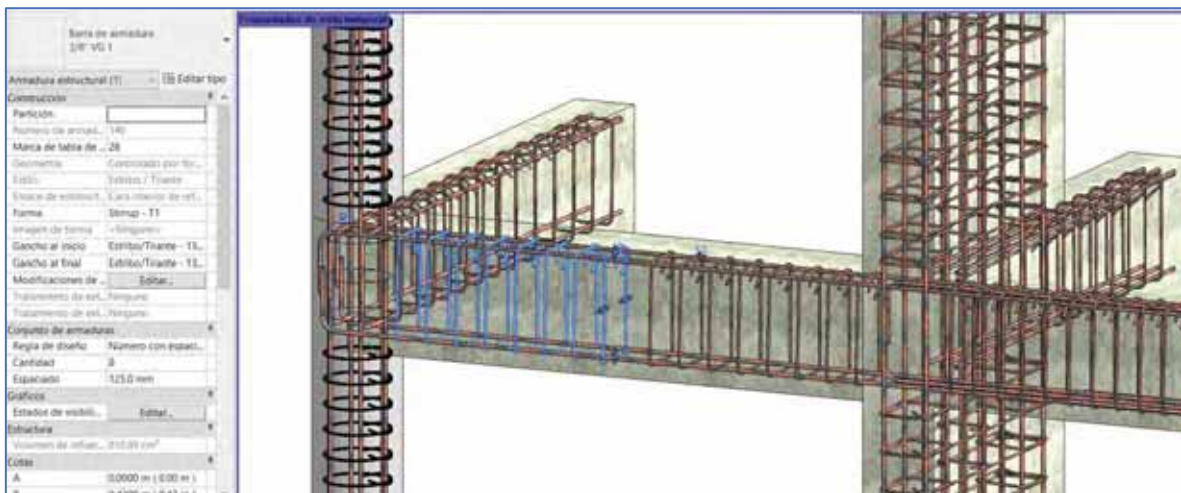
Vista de modelo BIM encuentro de acero entre viga, columna y placa, propiedades de elemento seleccionado (estribos de viga).
